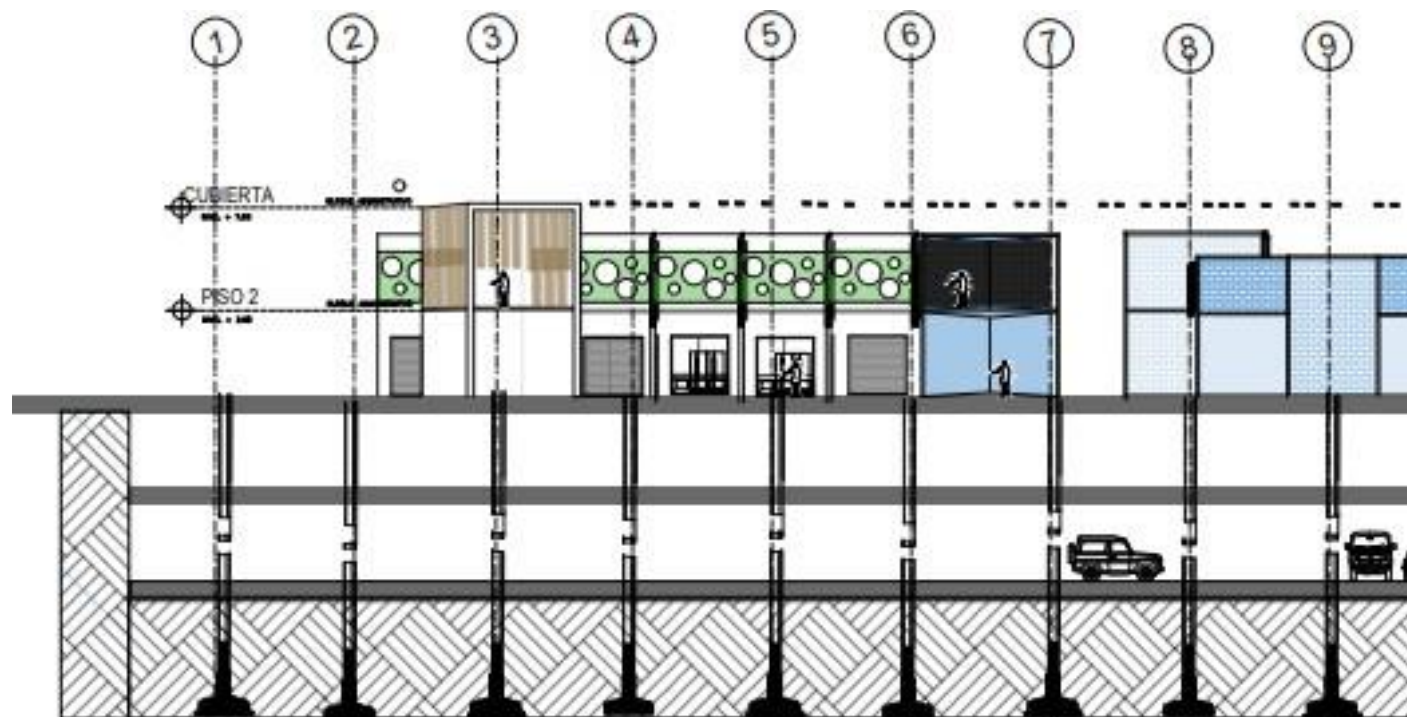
Fachadas, Cortes y sección módulo tipo 2.
